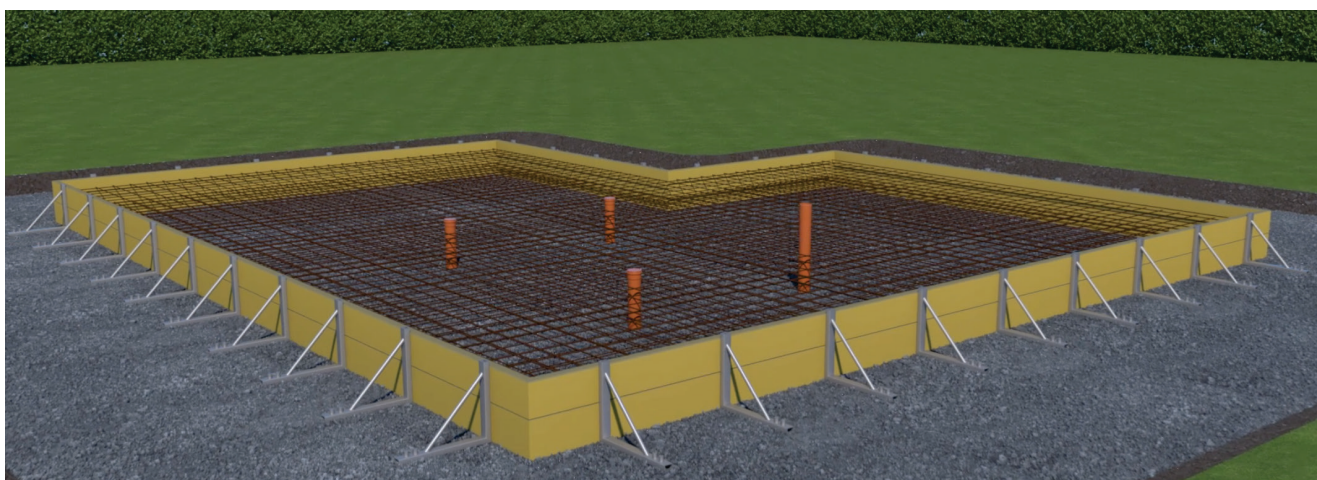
Изготовление фундаментной плиты с вертикальными трубами
